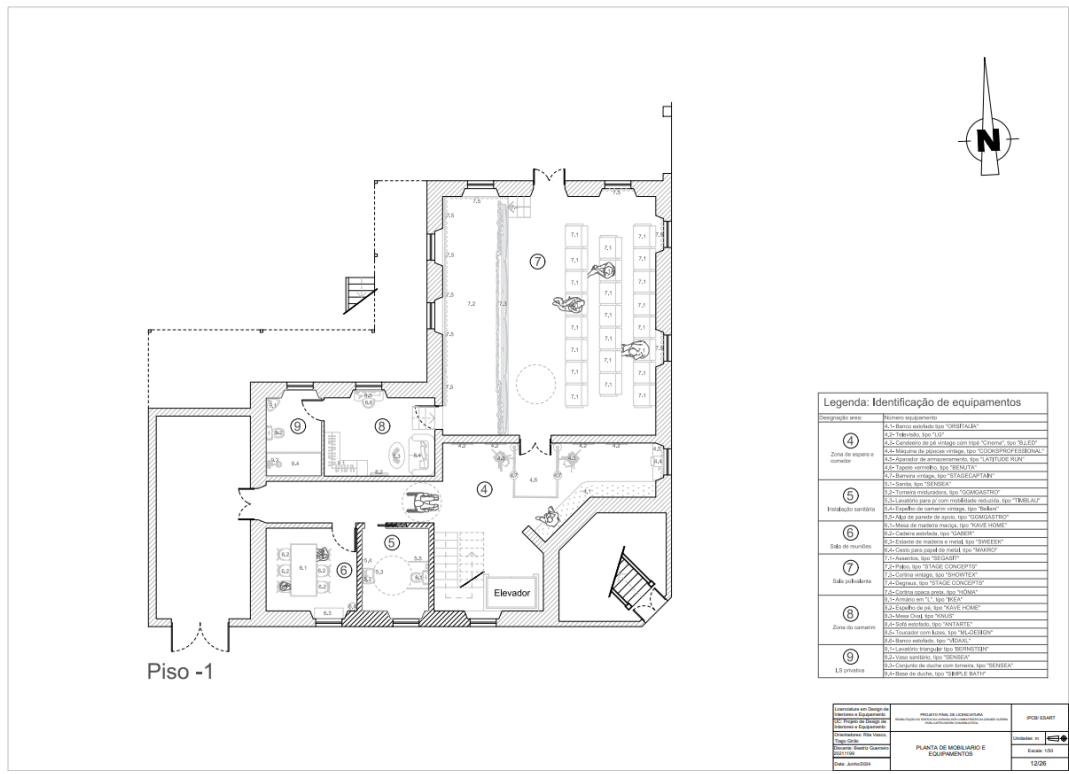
Planta de Mobiliário e Equipamentos, piso -1, sem escala. Fonte: Autor
